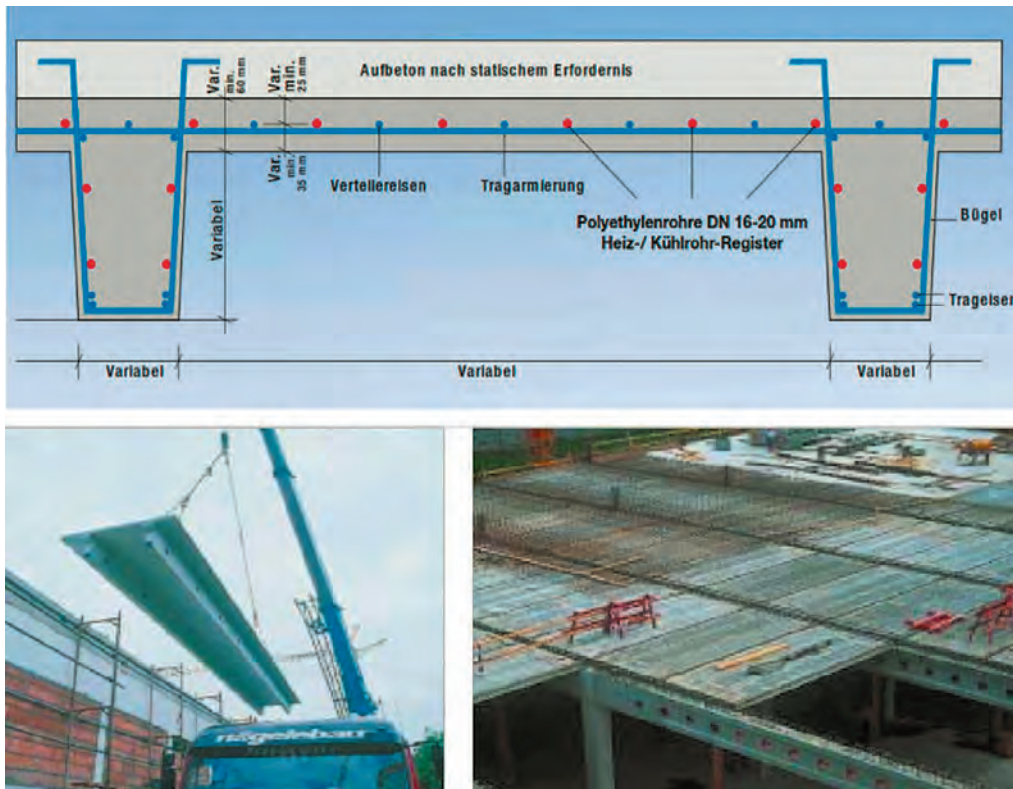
Esquemas y vistas de la instalación del sistema de losas prefabricadas termoactivas de hormigón armado. En la sección del elemento constructivo se aprecia como el fabricante, NAGELEBAU, aprovecha la totalidad de la superficie de losa y vigas como intercambiador termoactivo, modular, interconectable y de gran capacidad. Esta es una solución espectacular para resolver con una solución integrada de rápida ejecución la estructura y la climatización aprovechando toda la capacidad inercial de las losas. Fuente: NAGELEBAU/ENERCRET/ENERES.
